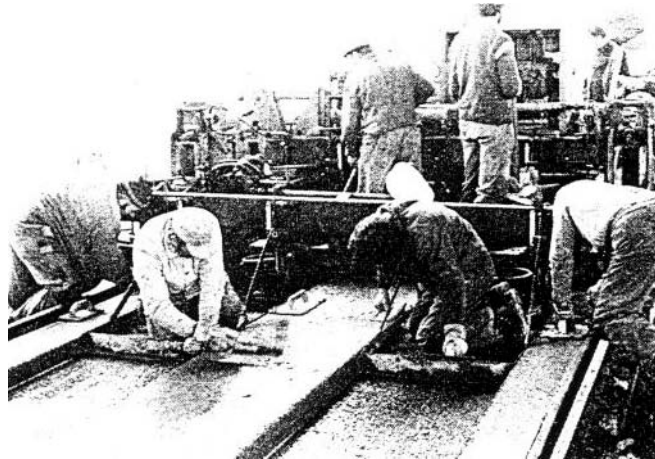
Herstellung der Betontragplatte mit Profil der Bauart Strabag [76]
